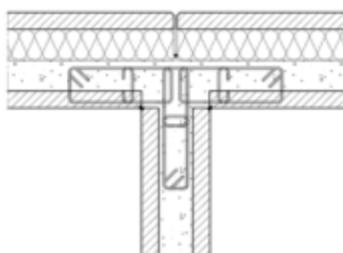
Joint d'angle vertical en T2.3.3.3.4. Joint horizontal droit
